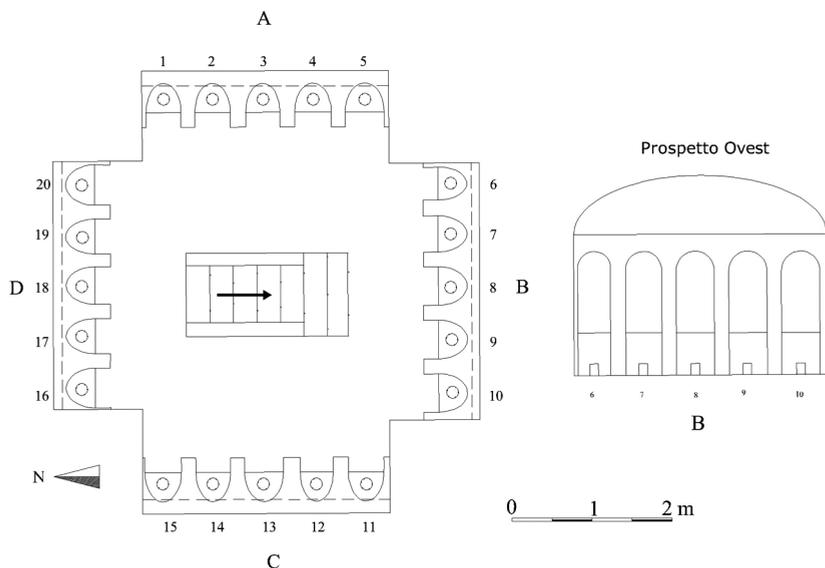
Pucara (SA), cripta del monastero di SS. Giuseppe e Teresa, pianta e prospetto ovest
